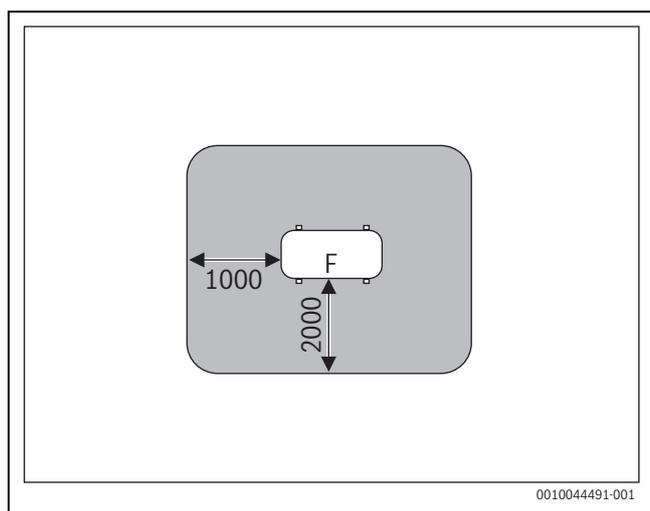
Área de proteção com instalação no chão na propriedade ou no telhado (dimensões em mm)
